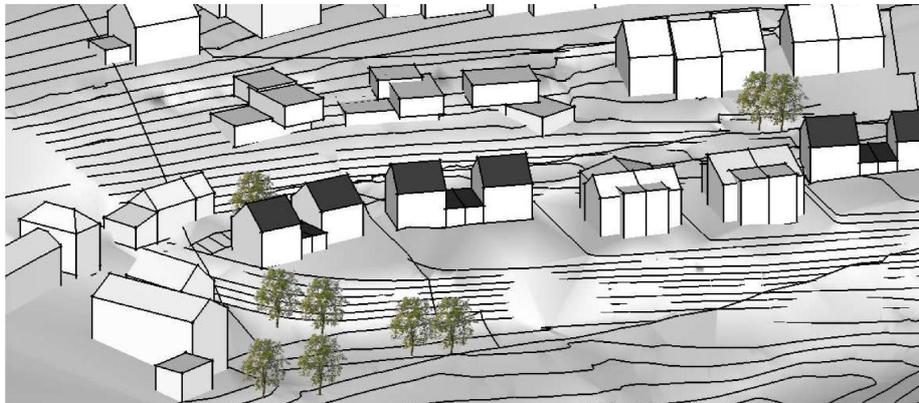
Straßenrandbebauung entlang der „Duerfstrooss“, südlich der bestehenden Rohbauten (o. M.). CO3, 2011.
